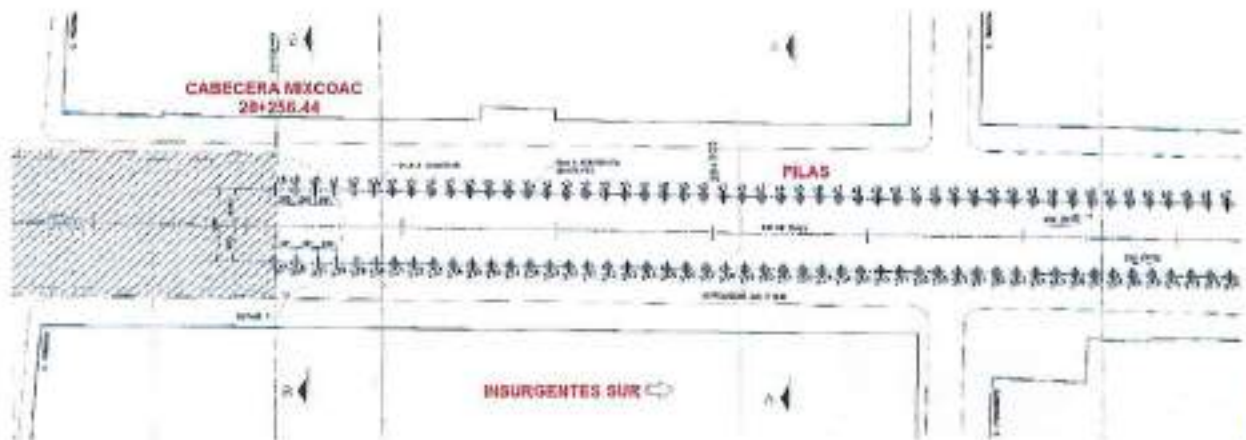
Planta de localización. Zona excavada con pilas llegada a la cabecera de la estación Mixcoac
